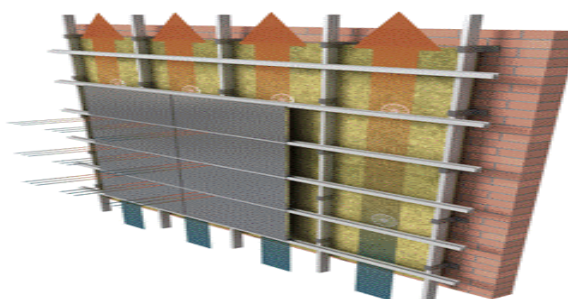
23 - Esquema construtivo em fachada ventilada [W41]
